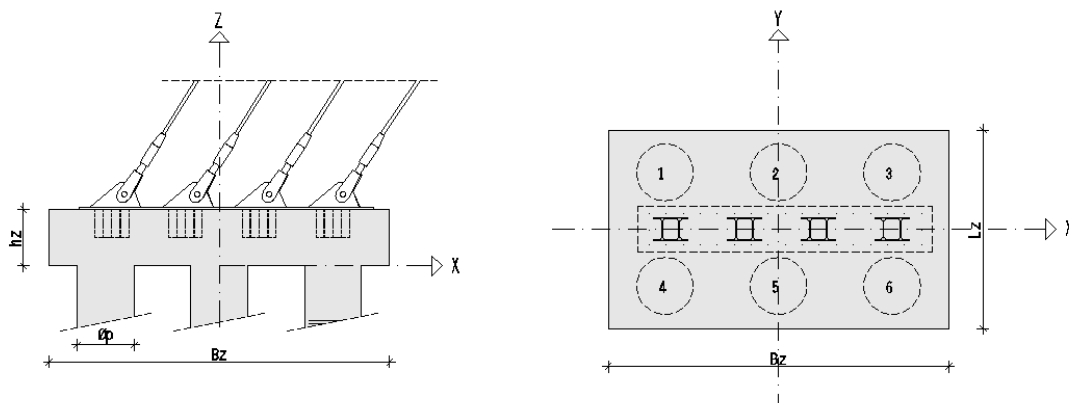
Pianta e sezione della fondazione di ancoraggio degli stralli
